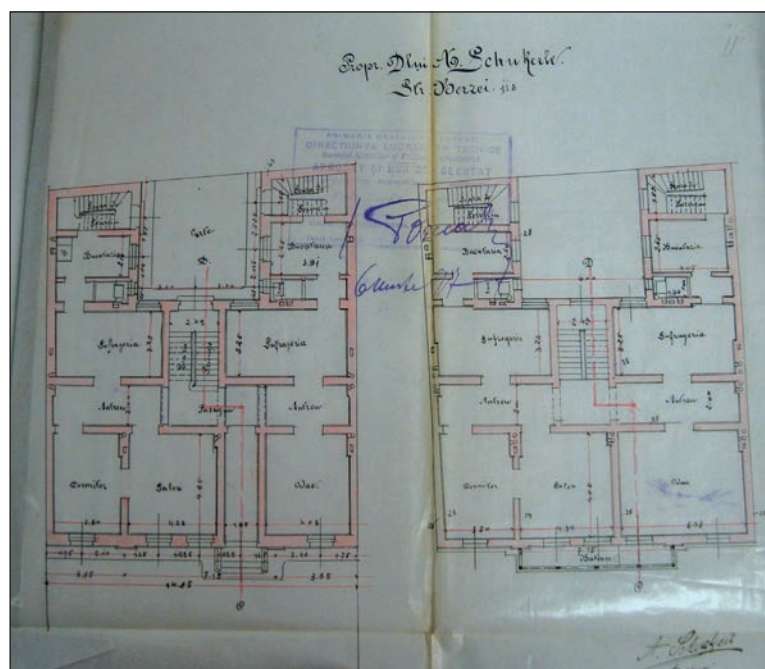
Corpul secundar: plan parter și plan etaj – în anul 1897
